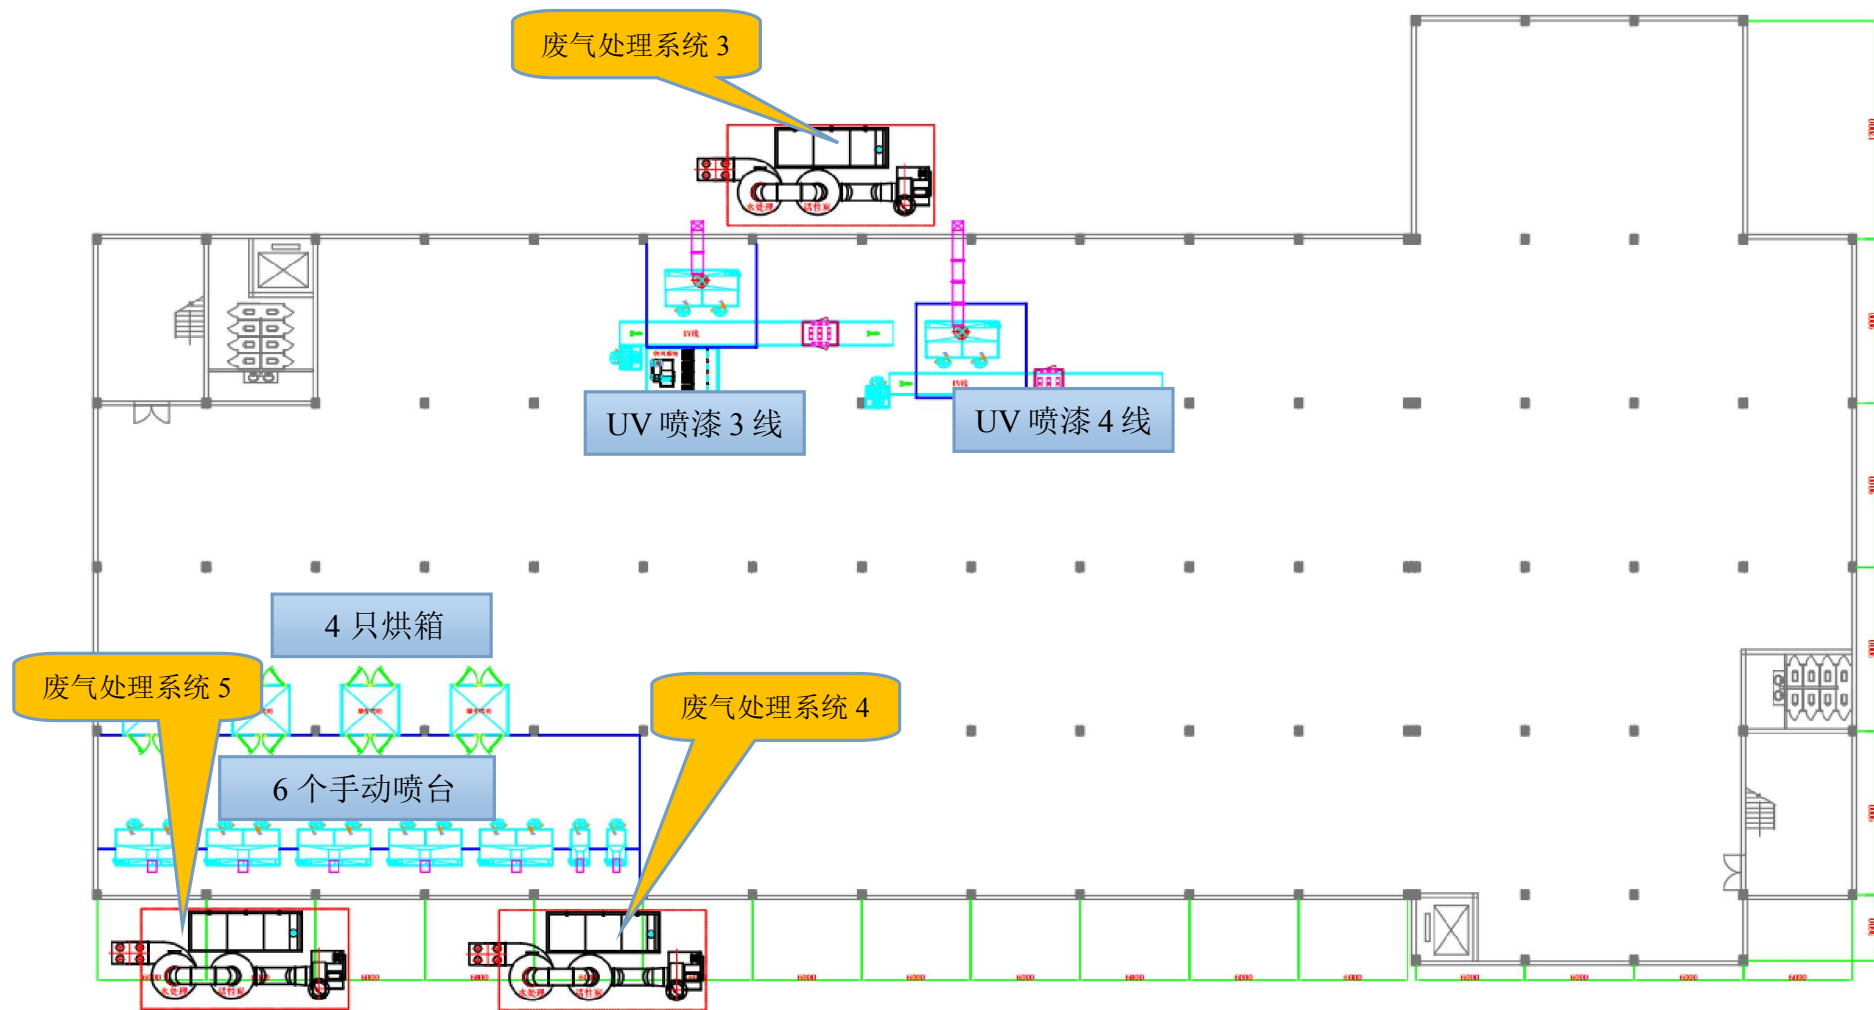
7#厂房 3F 喷漆车间平面布置图
